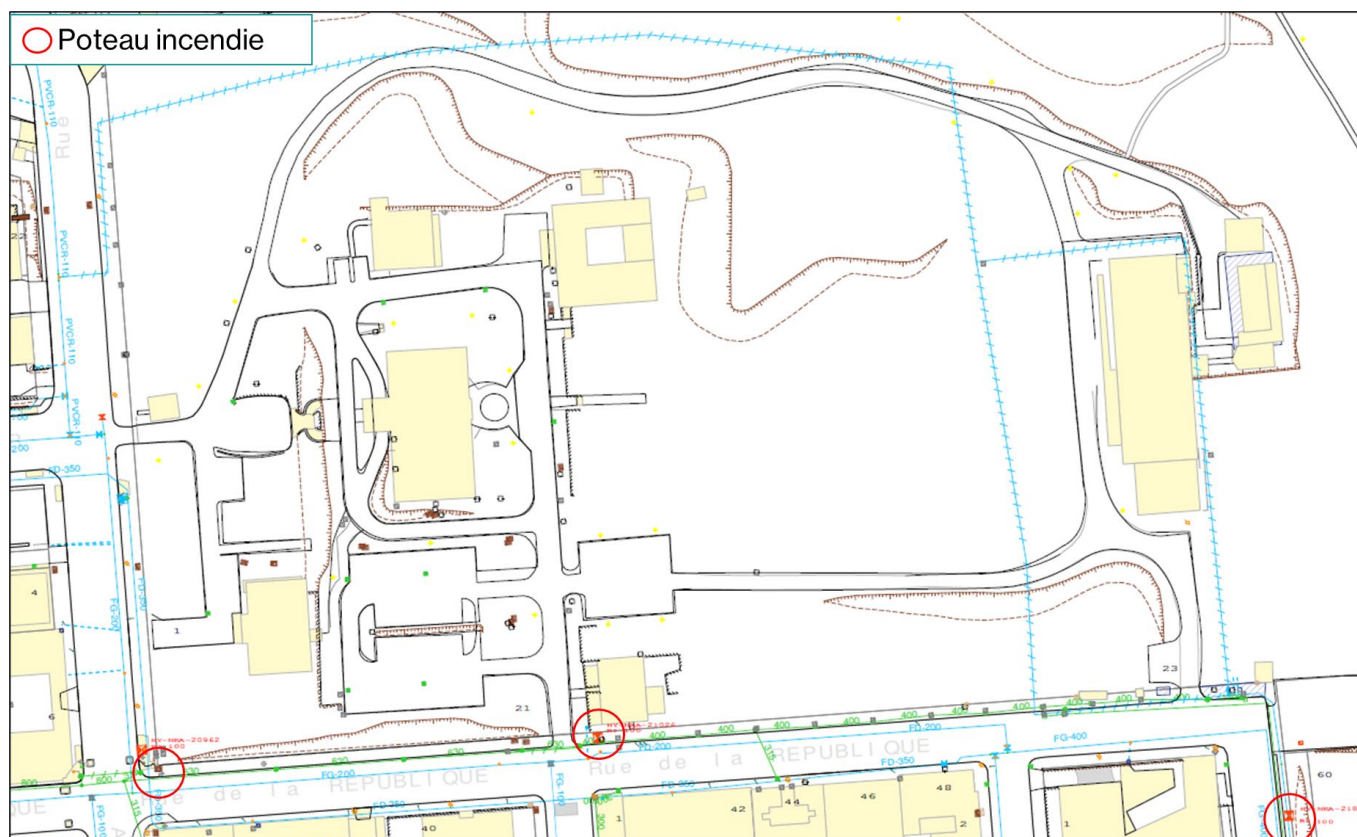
Plan de repérage des conduites AEP (sources : CDE)
